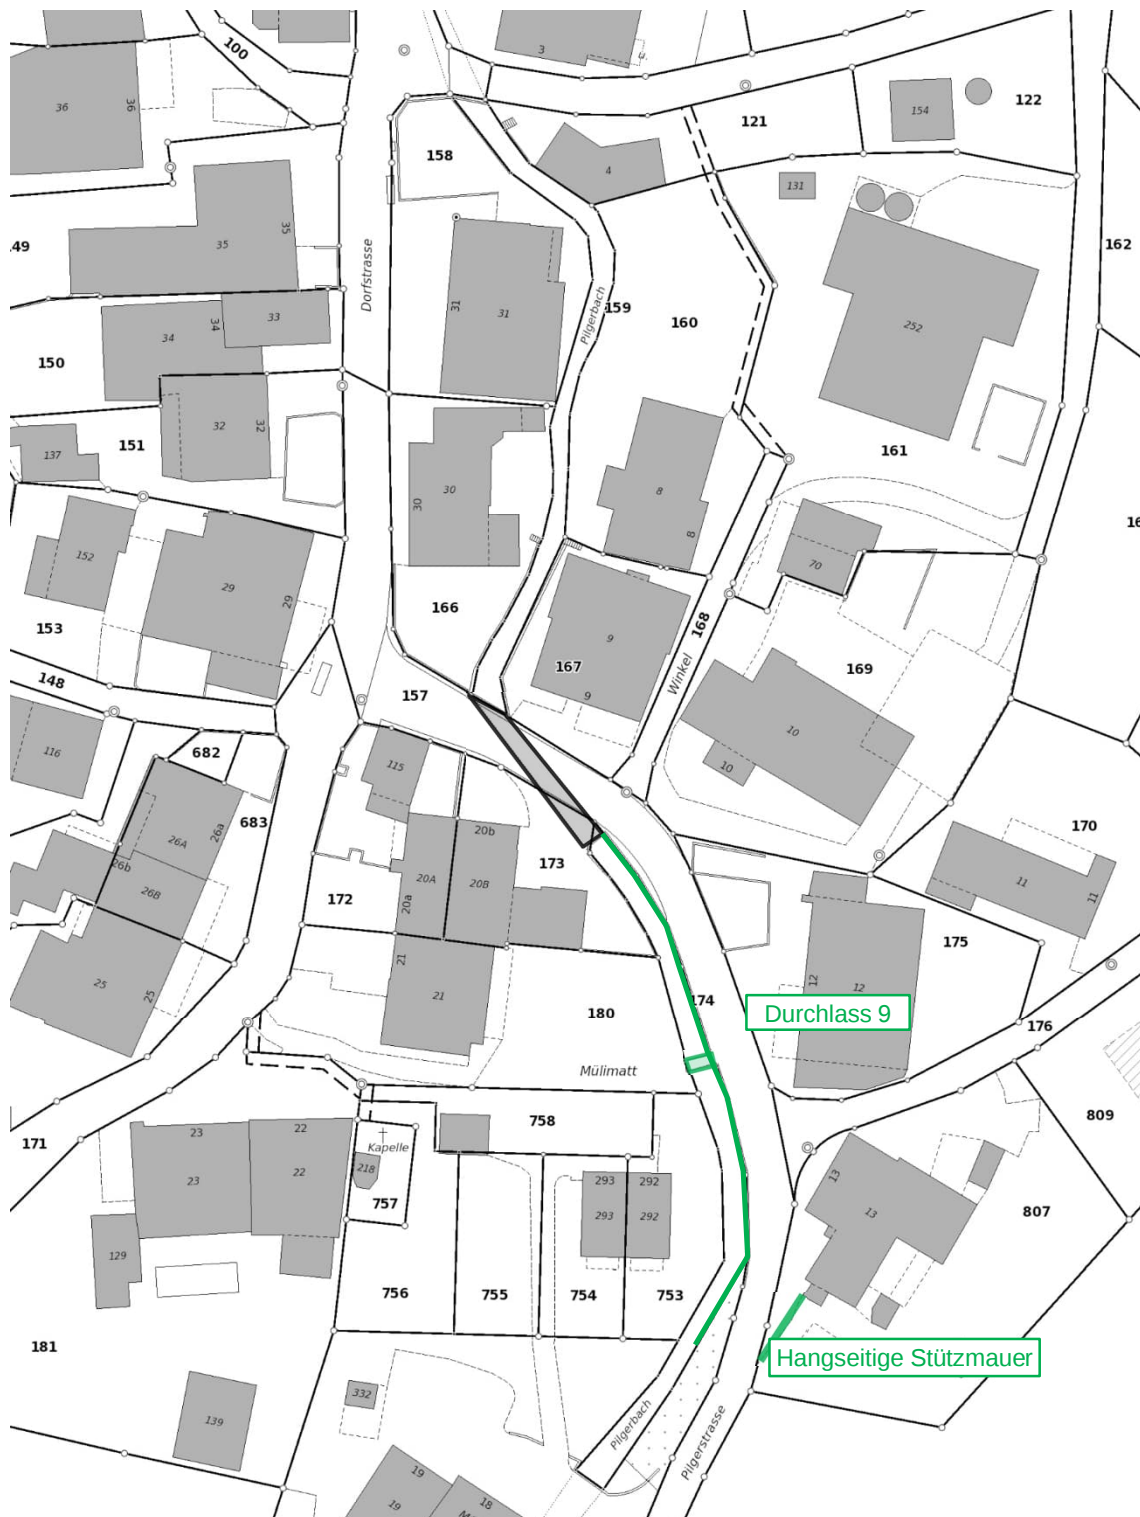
Lageplan mit Objektbezeichnungen (Teil 3/3)
